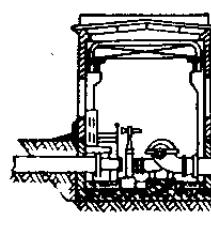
Раздельное здание насосной станции с сухой камерой и горизонтальными насосами.
